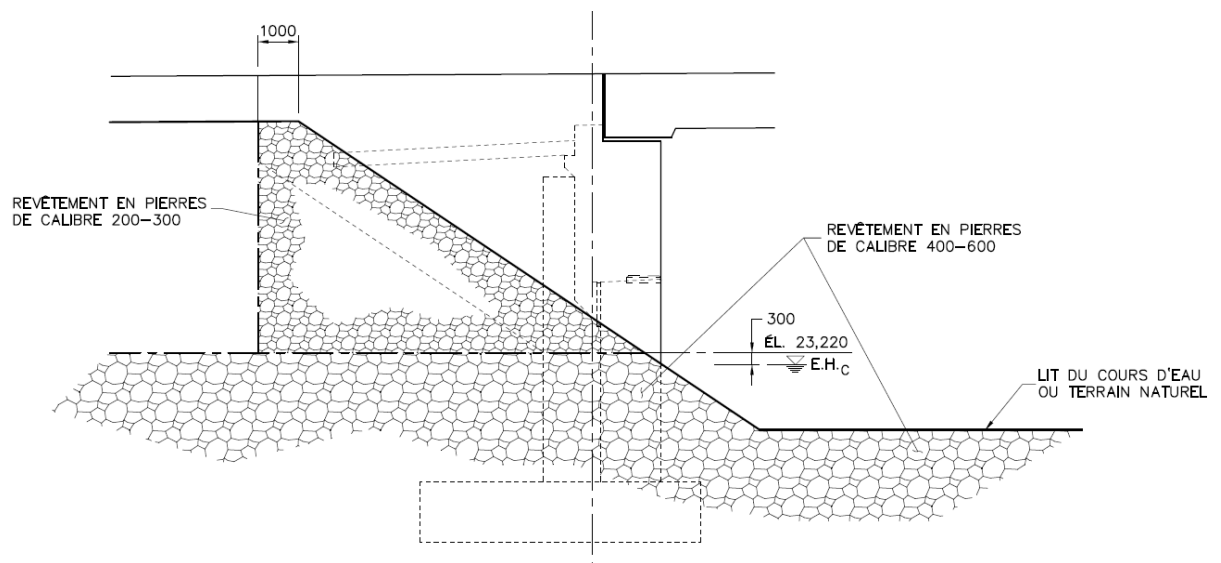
Coupe transversale de l'enrochement de protection des culées
